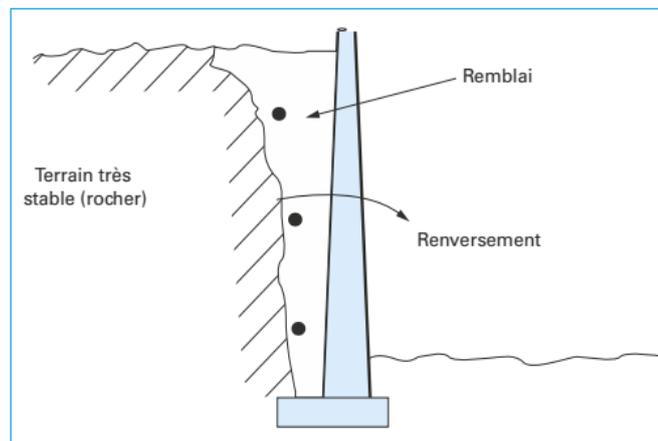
Mur soutenant un remblai de faible épaisseur.
